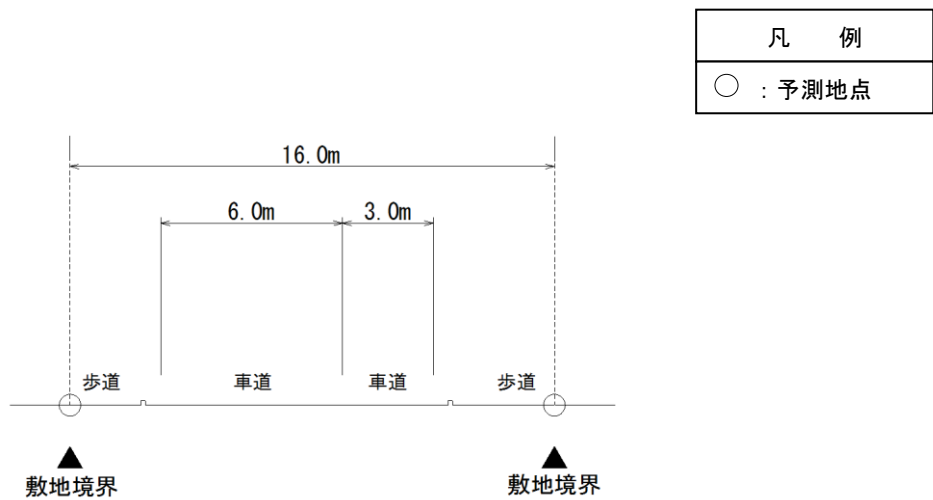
(3) 予測断面图 (C. 一般国道464号 (1))
